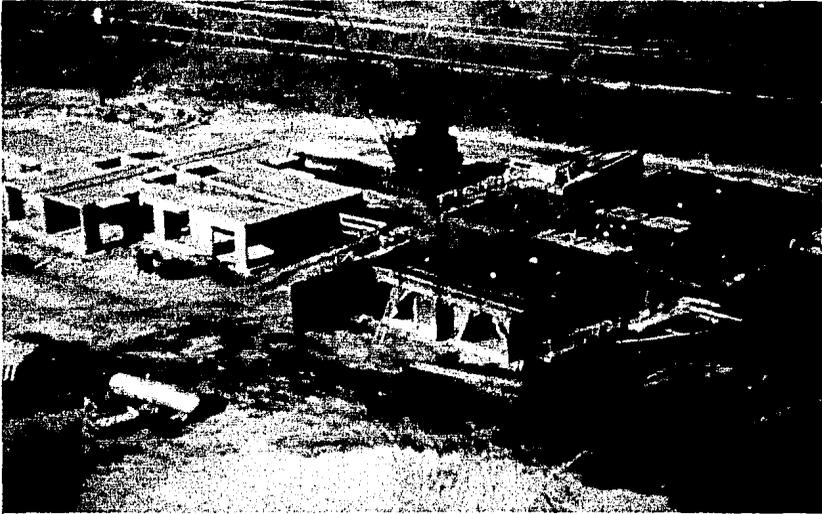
Proceso de construcción de la planta baja de un módulo de 4 casas.
